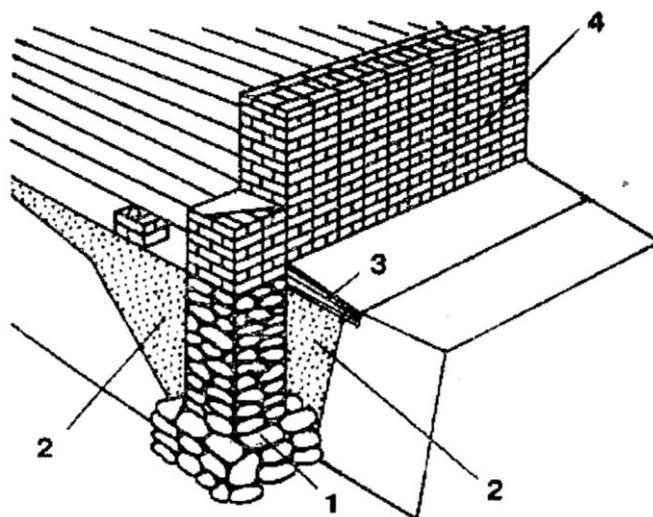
Столбчатый фундамент из бутового камня: 1 - бутовый камень; 2 – обратная засыпка грунтом; 3 - отмостка; 4 – забирка.
